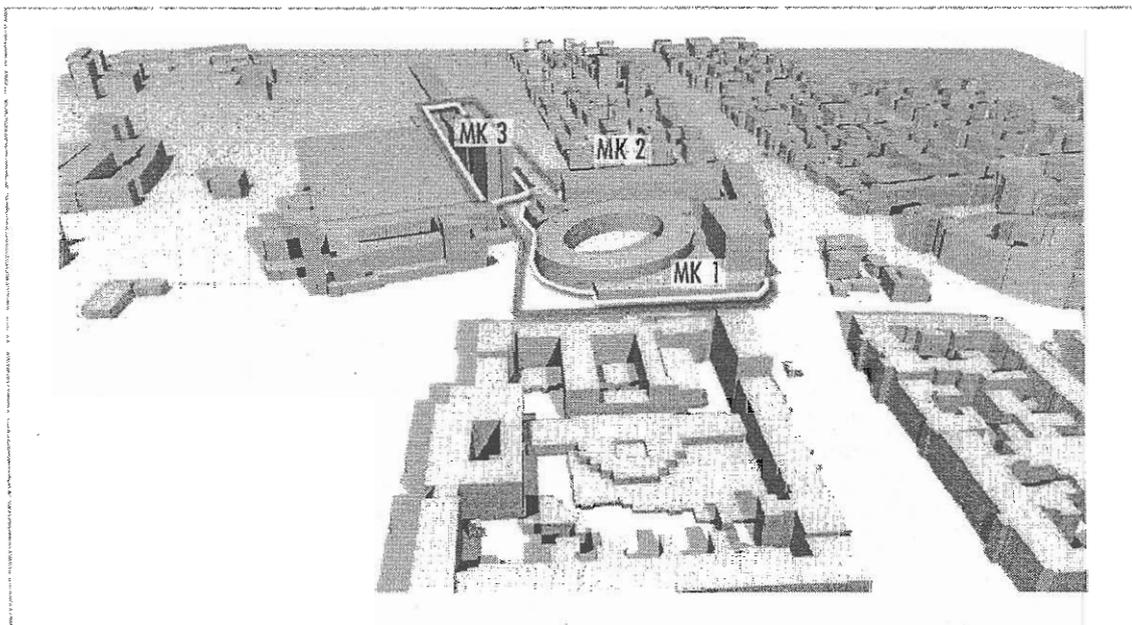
Baugebiete im Bebauungsplangebiet „Ehemalige Hauptpost – Wiesbaden“
